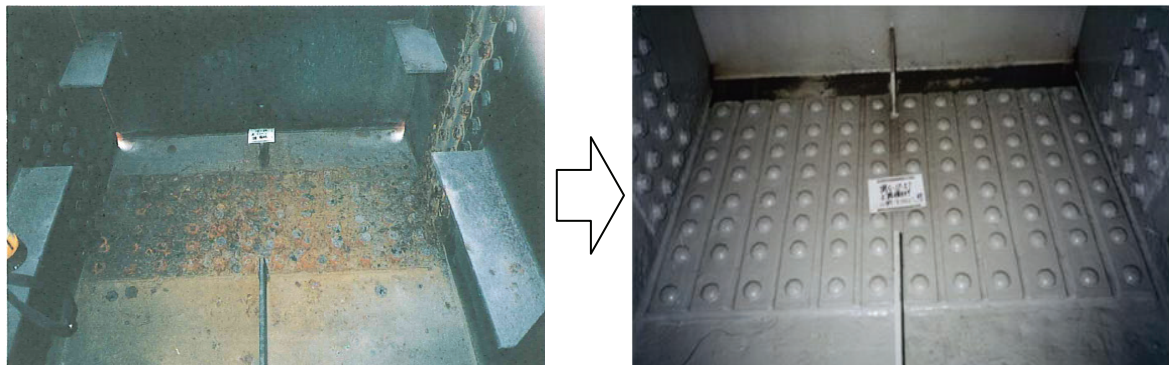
補強添接板工法の施工前後の写真²⁻²¹⁾
